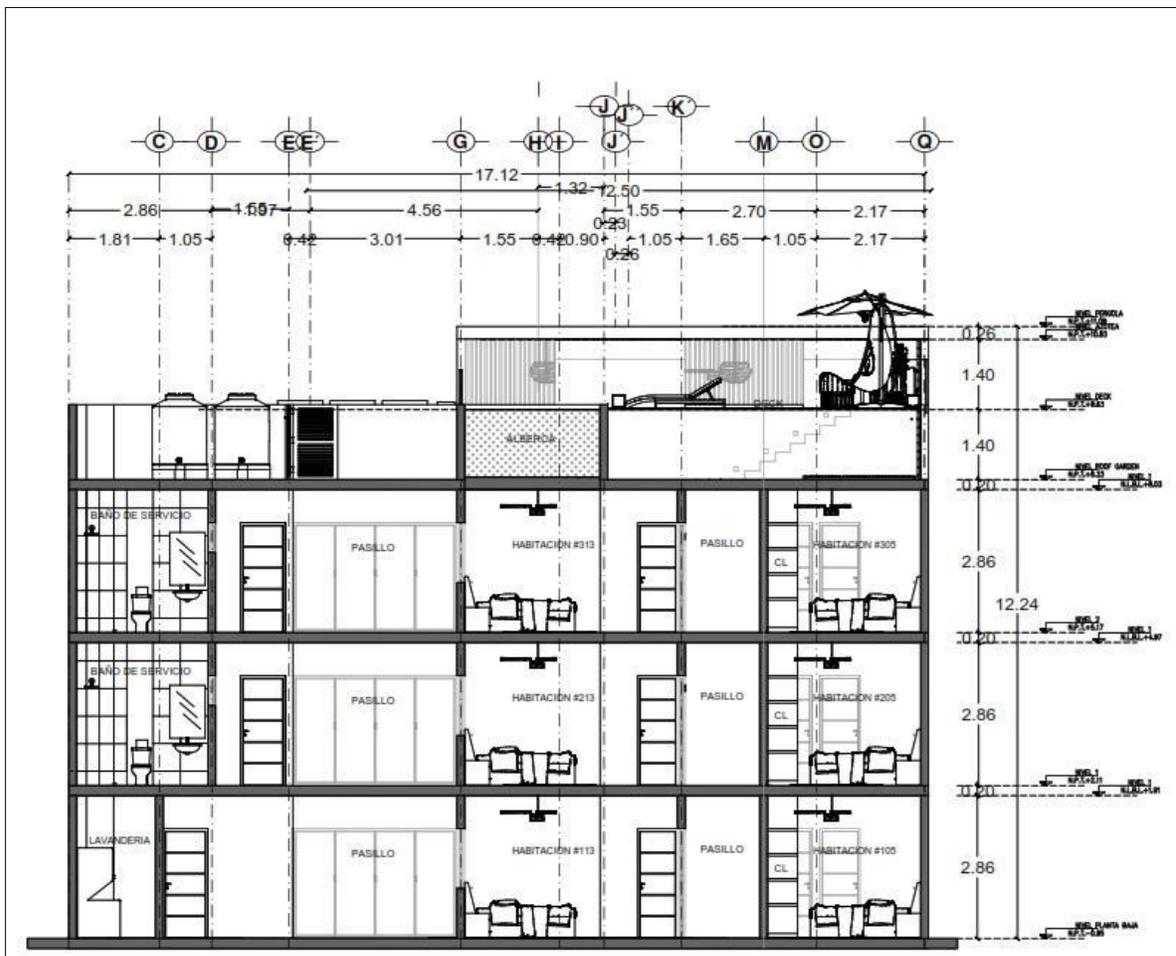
Corte transversal del Hotel Santa Cruz Mazunte.
